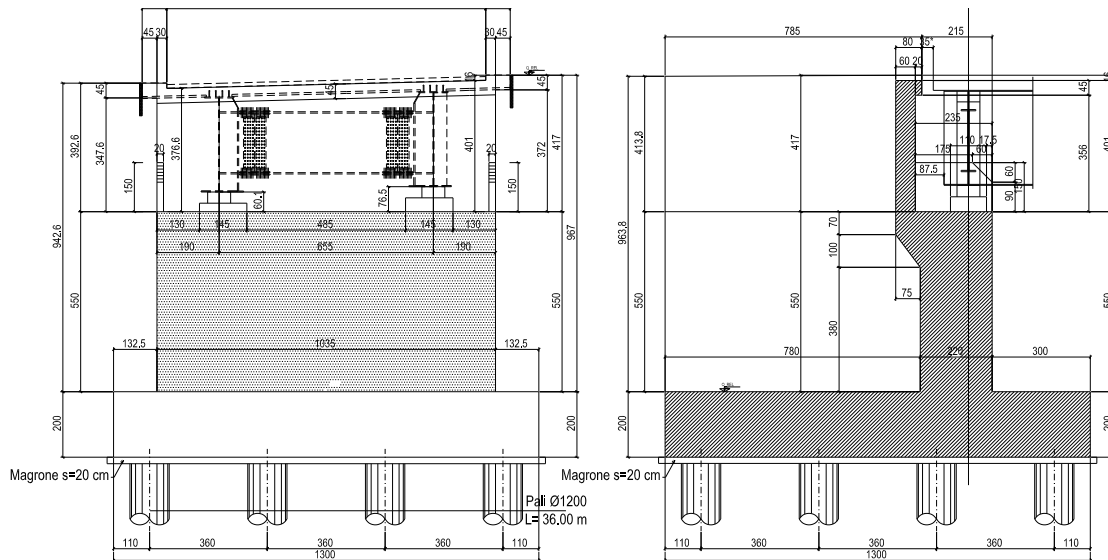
Vista frontale e sezione longitudinale spalle SP1
